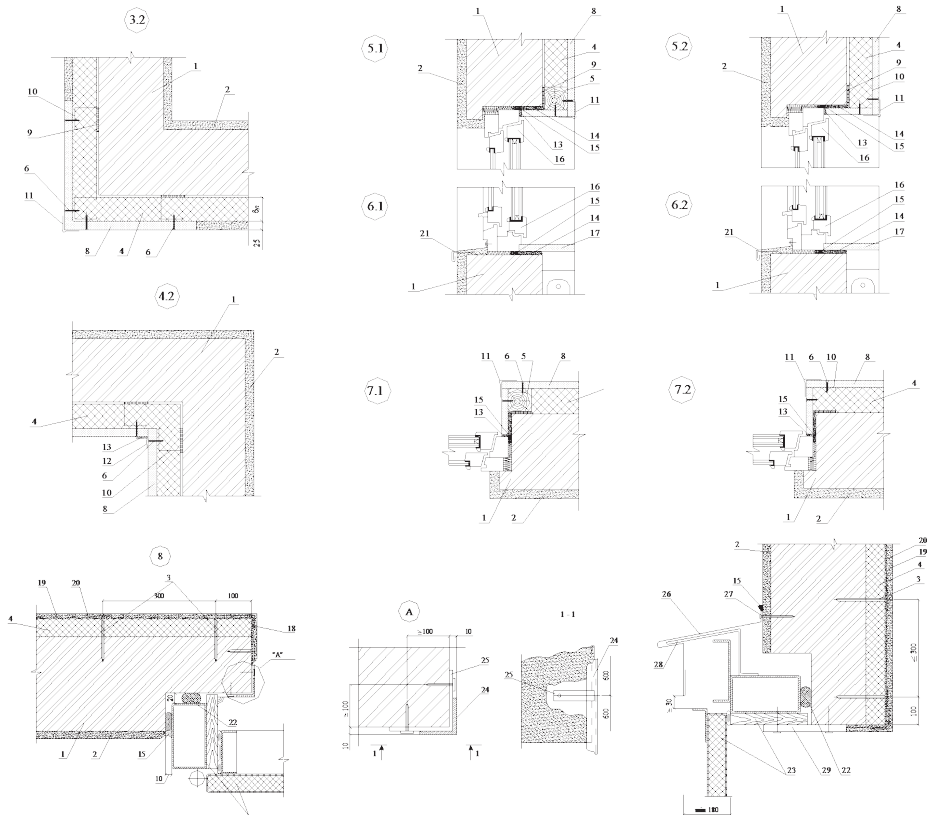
Вузли конструкції зовнішніх стін із теплоізоляцією розташованою з боку приміщень. Вузли 4.2. – 8
